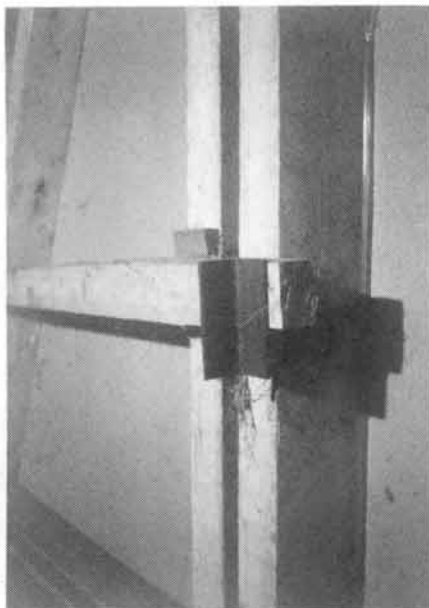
La porte est verrouillée par des poutres transversales; construction permettant d'éviter des fuites d'air.
